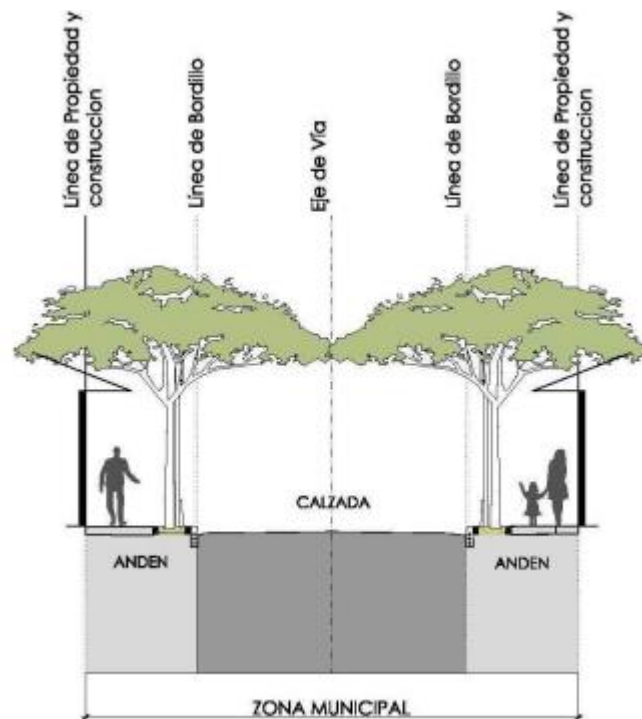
Componentes de una sección o perfil vial de un sector planificado
